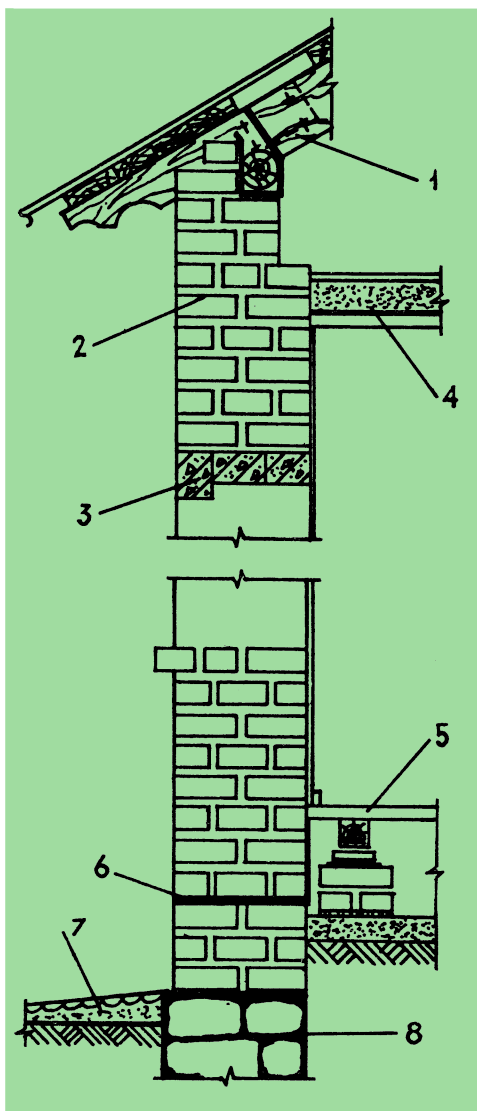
Разрез стены из сплошной кирпичной кладки:
